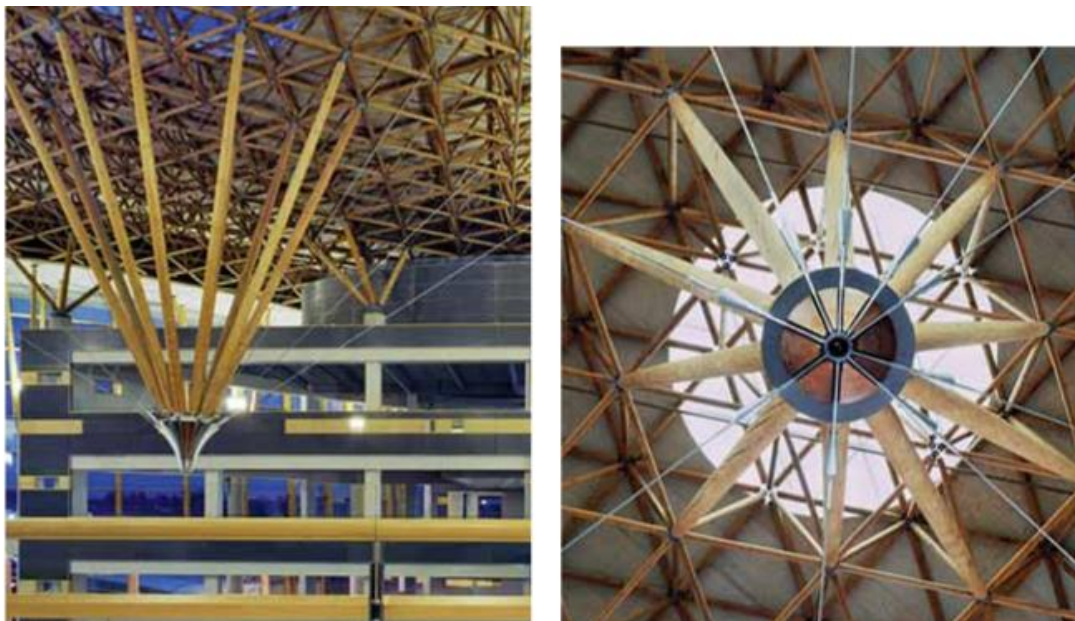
Centre commercial Central City à Surrey (C.-B.) (photo : Structure Craft Builders).
